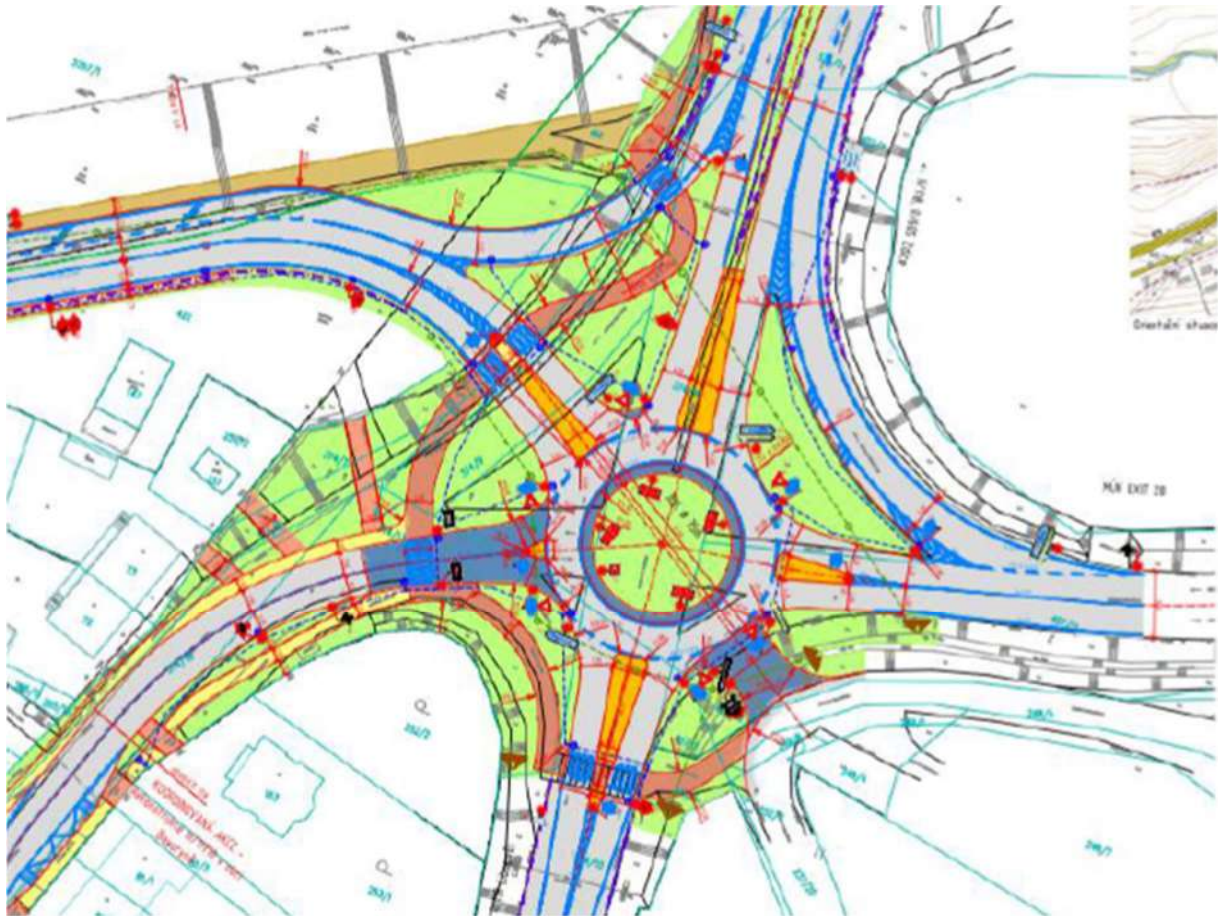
Trasa plánovaného obchvatu Bavoryně
